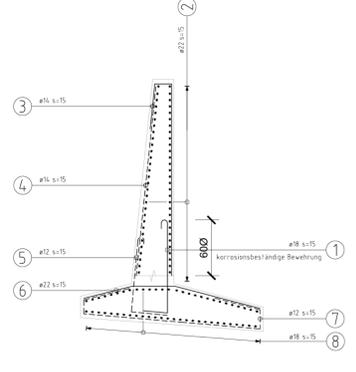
Bewehrungsskizze Winkelstützmauer Typ 1
